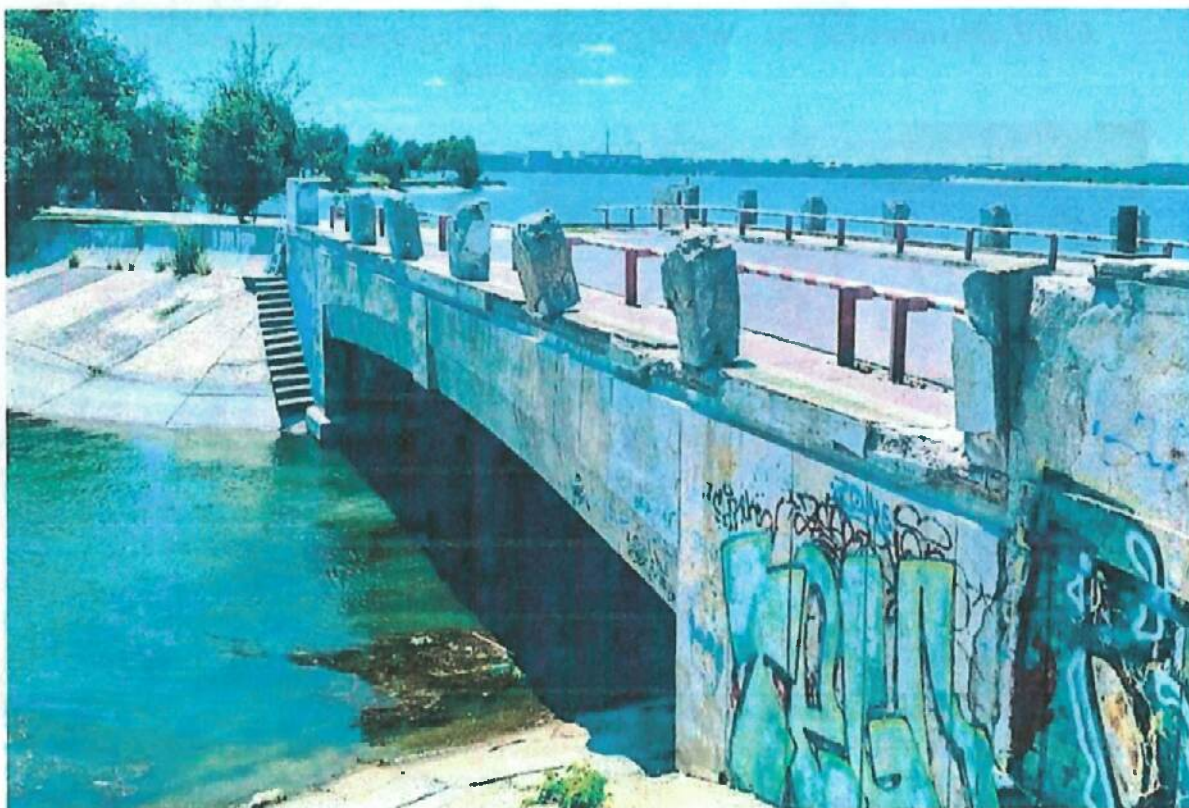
Grinda marginală boltită și parapet pietonal lipsă, sfert de con aval, spre insulă, lipsa parapet la scara de acces sub pod în aval, spre insulă
